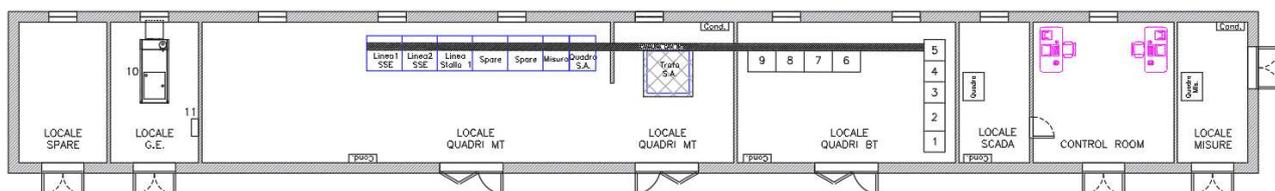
Stazione Elettrica Utente Stallo 1 – Planimetria
